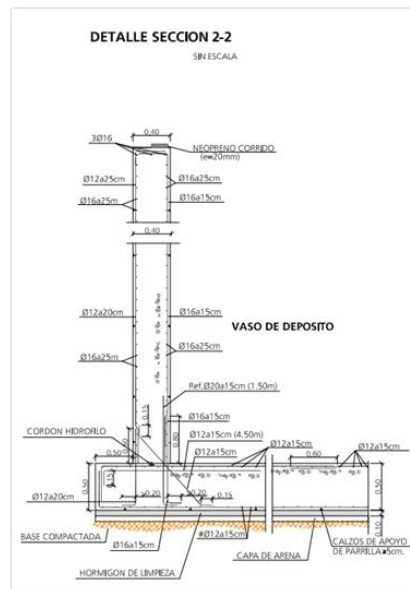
Detalle de arranque de muros perimetrales y solera: muro perimetral
